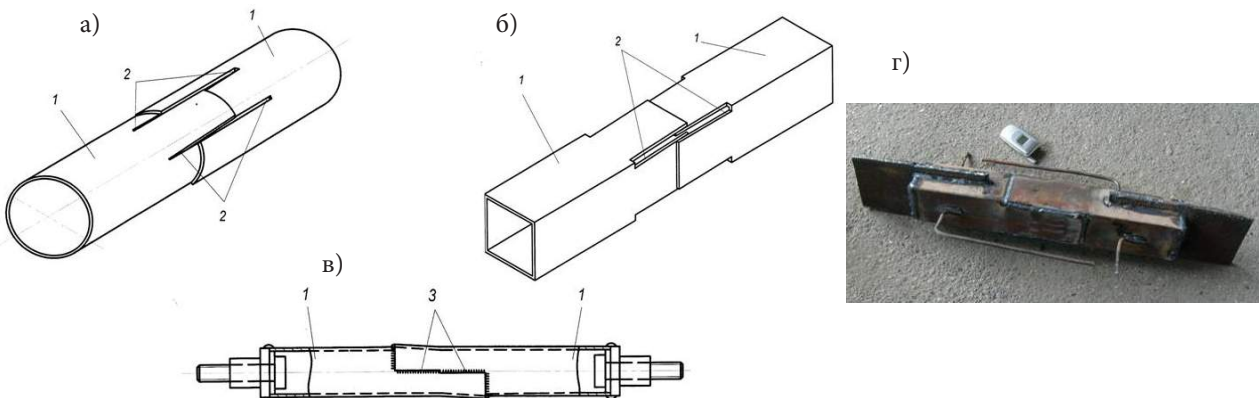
Схемы стыковых сварных соединений: а – стержневых элементов из круглых труб; б – стержневых элементов из прямоугольных труб; в – стержневых элементов из унифицированного сортамента структурных конструкций системы «МАрХИ», «Кисловодск», модернизированных для повторного применения; г – снимок опытного образца из квадратных труб сечением 80 × 80 × 3 мм до его испытания на разрыв; 1 – стержневые элементы; 2 – продольные прорезы; 3 – сварные швы
